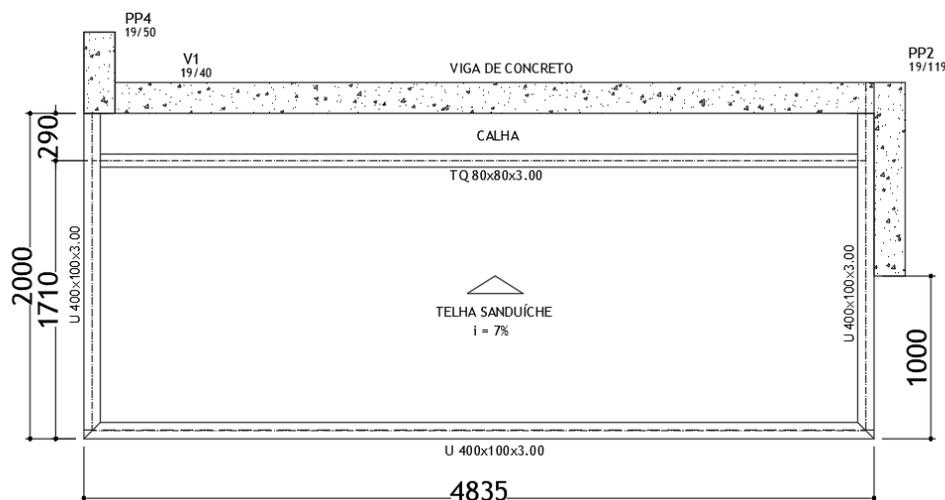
Planta baixa da marquise metálica executada no empreendimento
